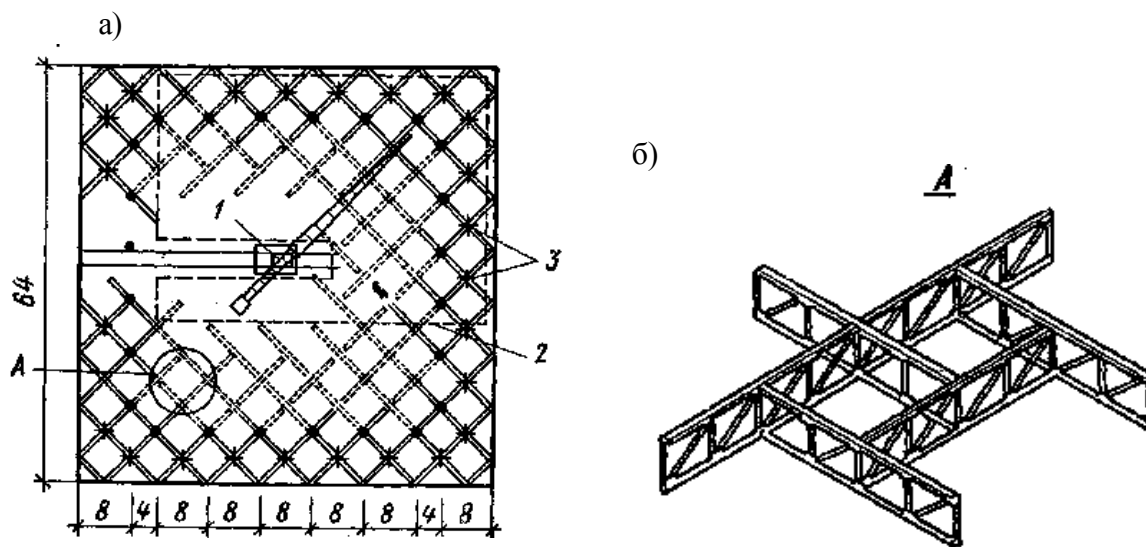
Конструкция перекрестного перекрытия над залом Дома мебели в Москве:
